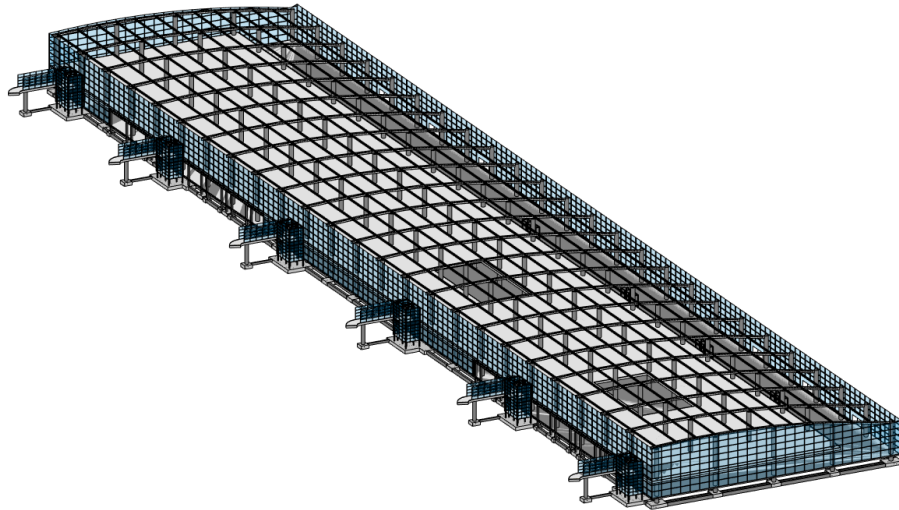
Vista 3D de la estructura completa con los cerramientos de muro cortina.
